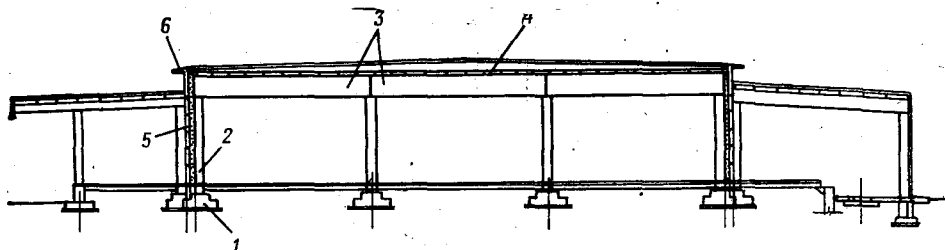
Сборный железобетонный каркас одноэтажного холодильника (поперечный разрез):
